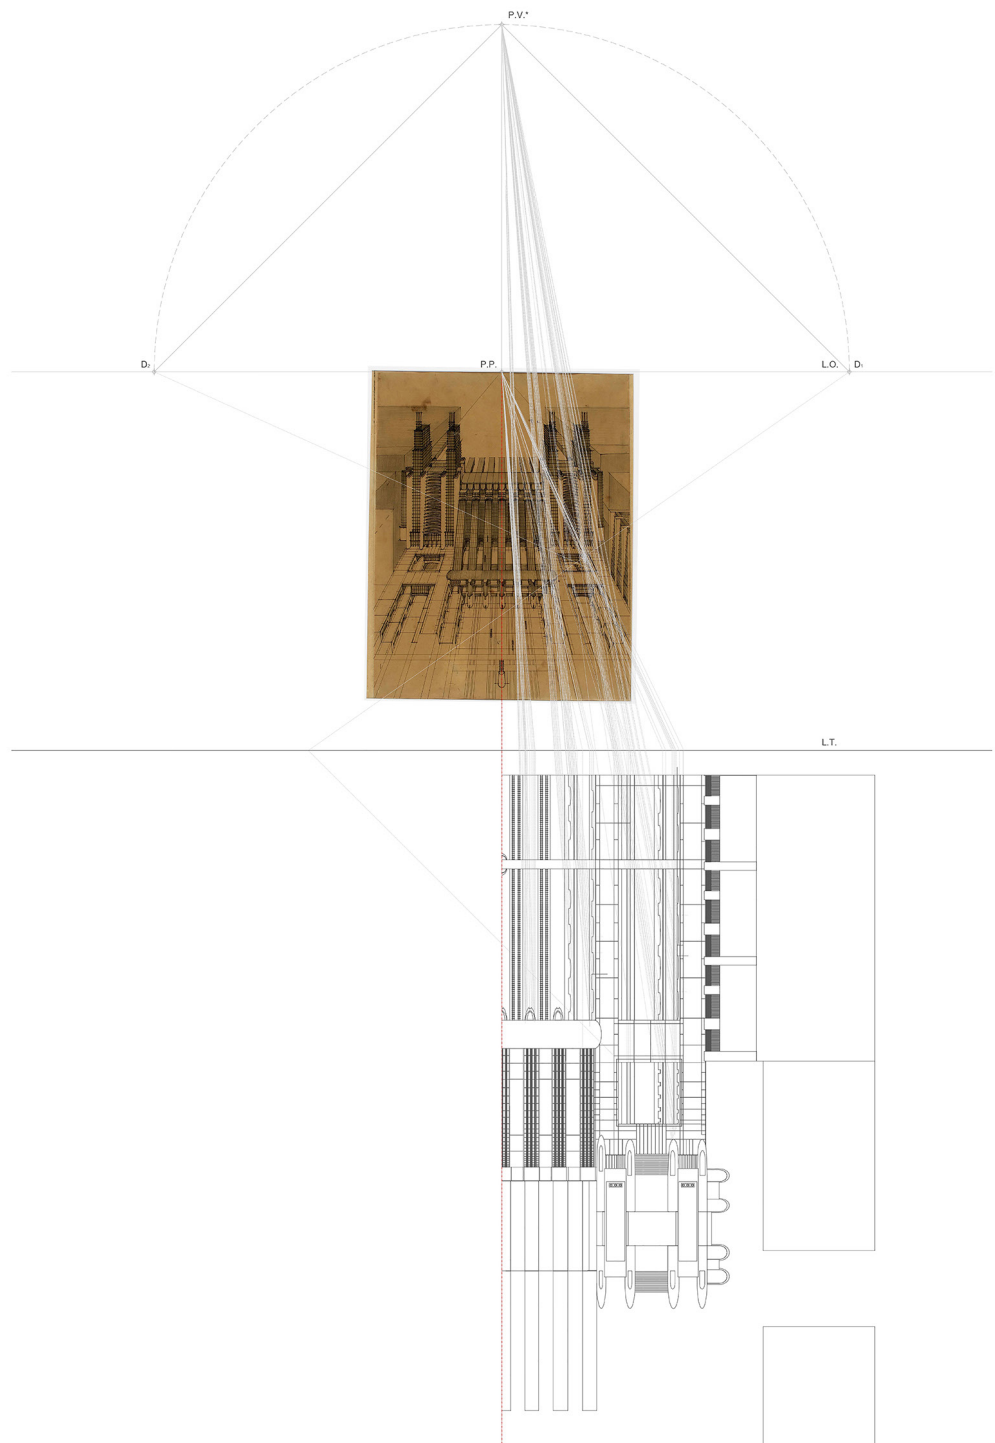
Restituzione prospettica della planimetria (elab. Alberto Antonini).
